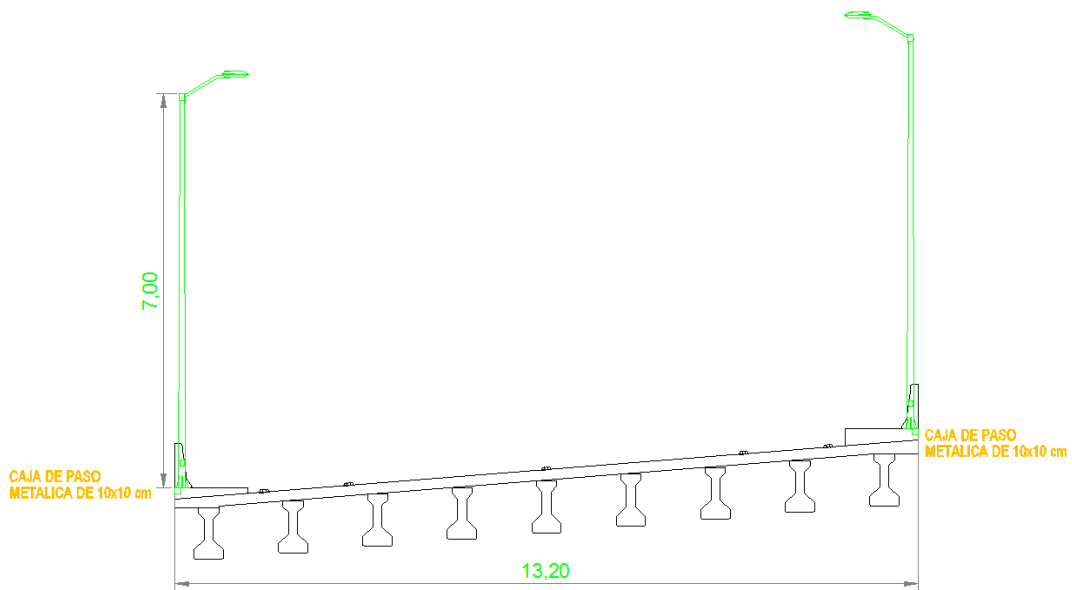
VISTA TRANSVERSAL DEL PUENTE
